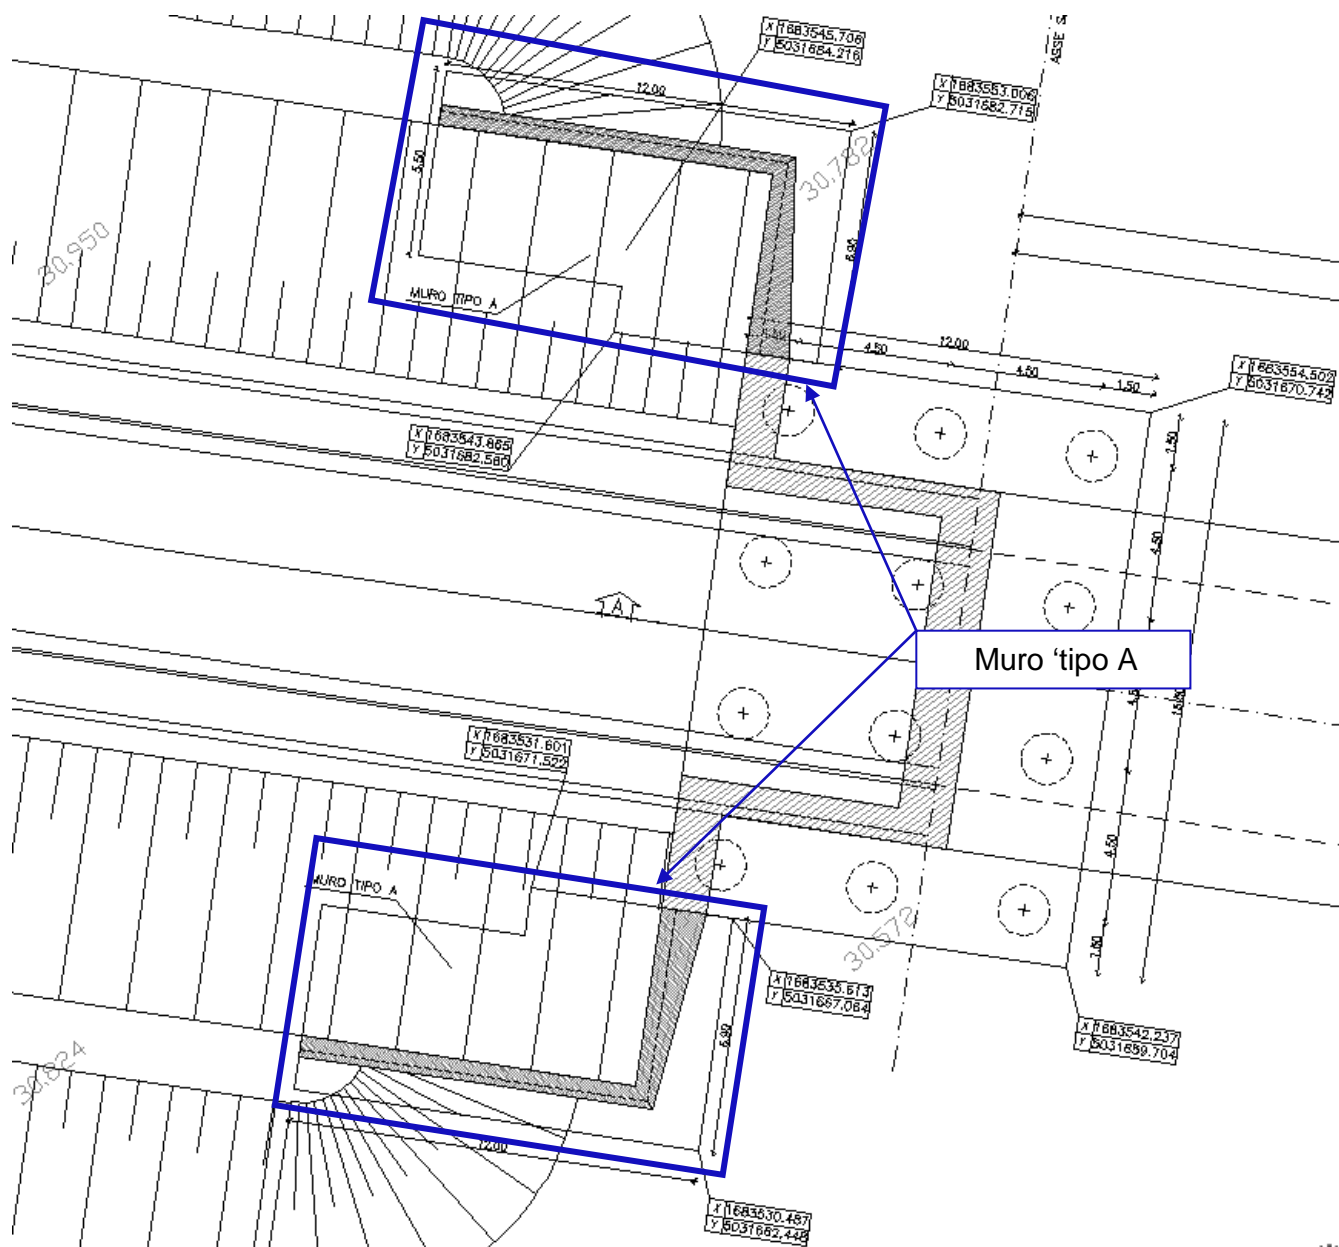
Stralcio planimetrico: ubicazione muri in c.a. lato spalla A
